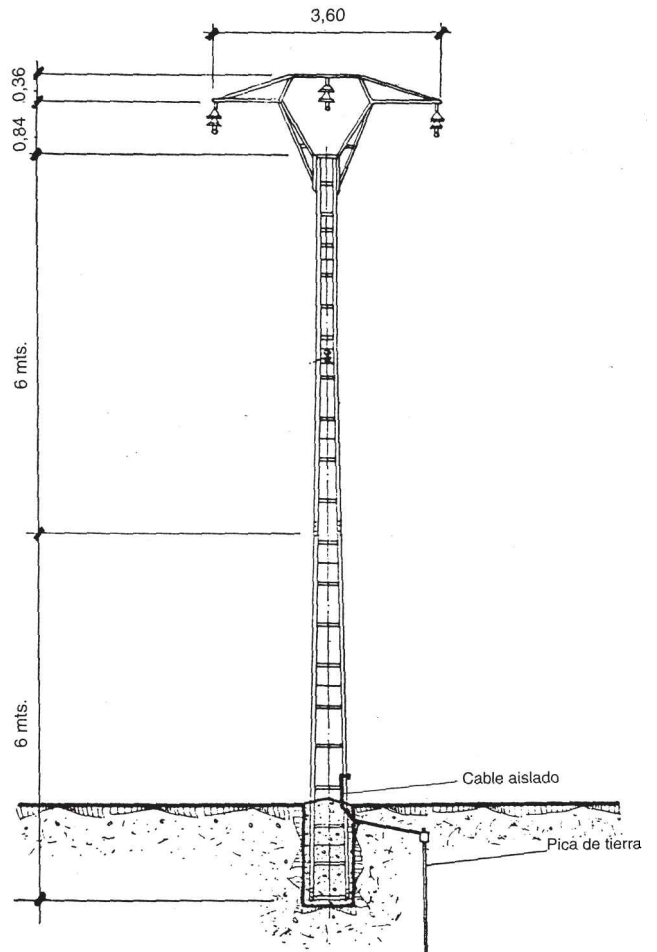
Puesta a Tierra de apoyos metálicos tipo presilla, con una pica de tierra.
